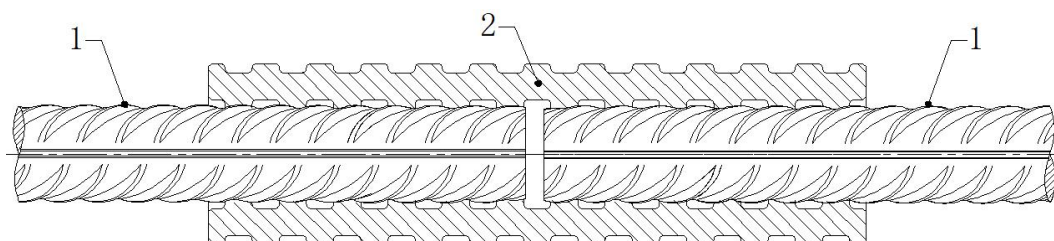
带肋钢筋直螺纹-套筒挤压复合接头示意图
